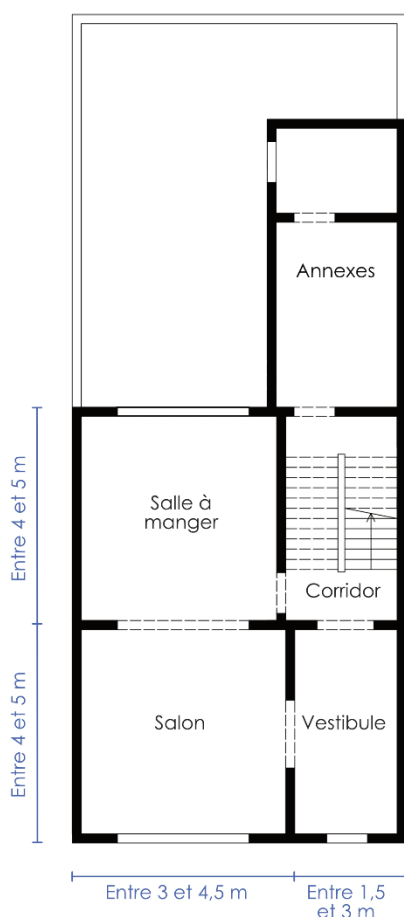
Dimensions intérieures en plan de la maison bourgeoise liégeoise
